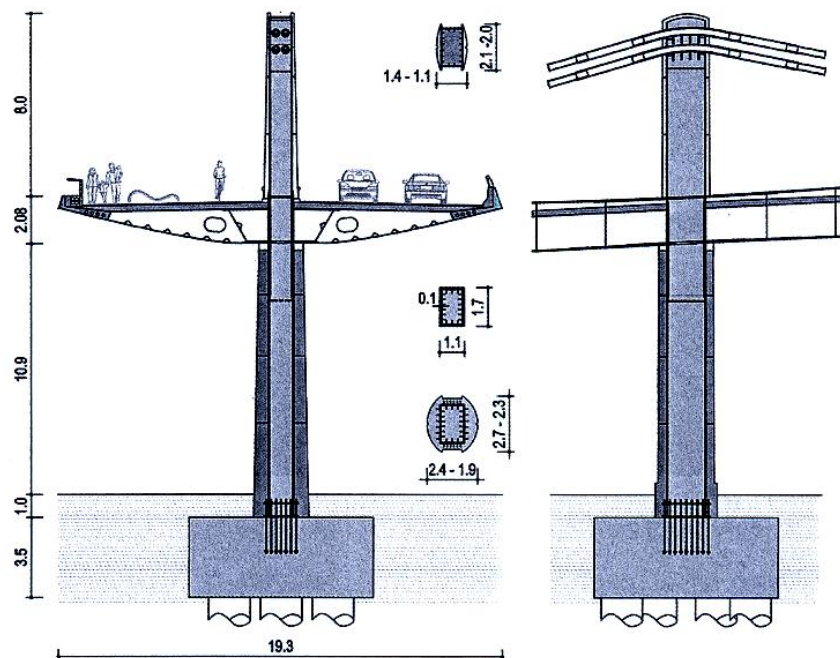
Сталежелезобетонная опора и пилон висячего моста чере реку Эбро в Испании [9]
